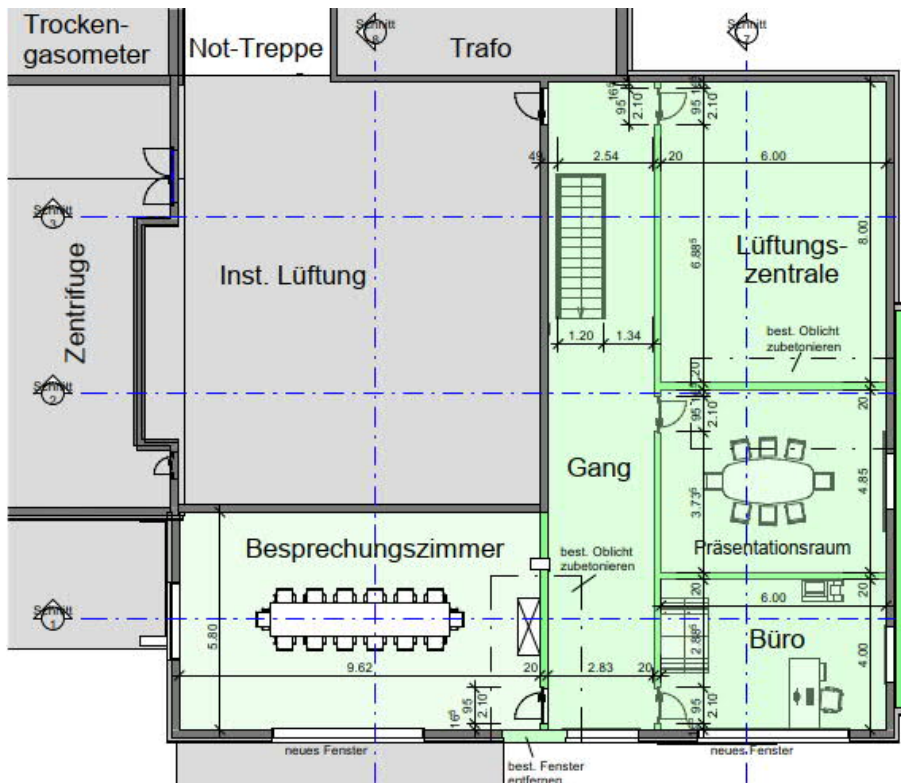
Erweiterung Betriebsgebäude; Planausschnitt Zwischengeschoss über EG
